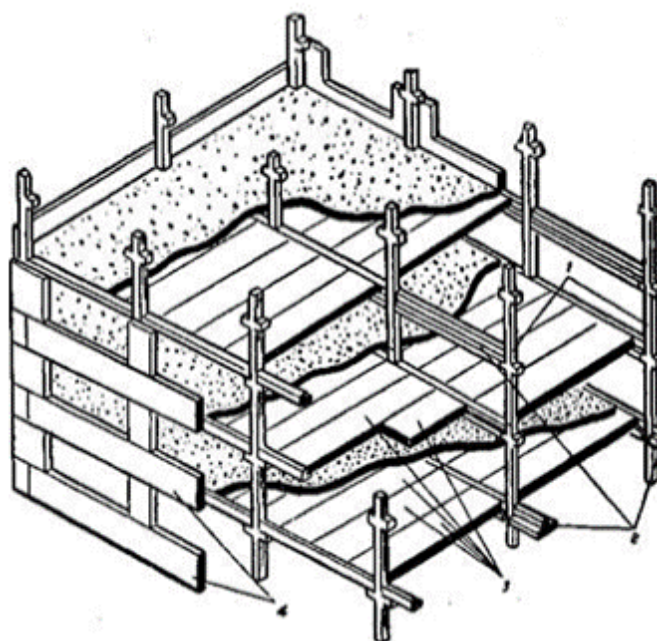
Конструктивная схема каркаса многоэтажного здания: 1— колонны; 2 — ригель; 3- плиты перекрытий; 4 —панели наружных стен.
